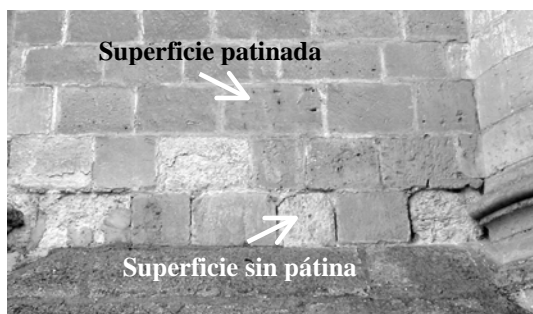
Detalle de una fachada del monasterio de Santa María de la Vid (Burgos). En la imagen se observa el deterioro de la piedra en las superficies sin pátina.
